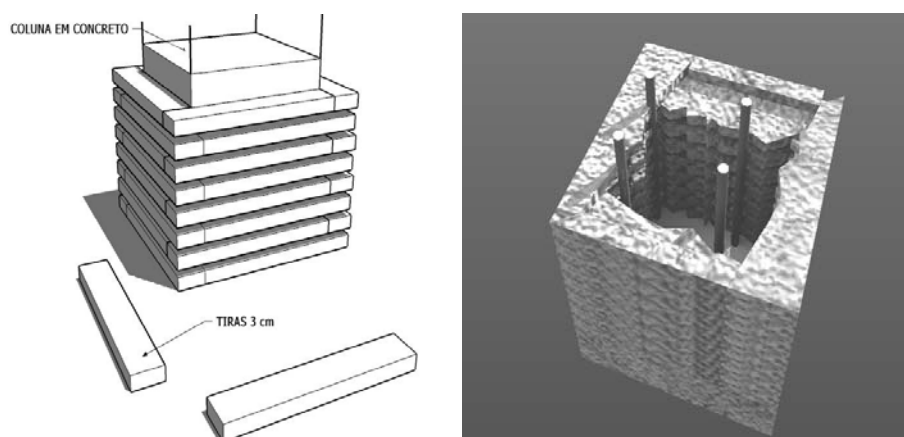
Colunas em Tiras aplicadas. Assentes com face serrada para dentro – preenchidas, em etapas, com concreto.(Desenhos do autor).
